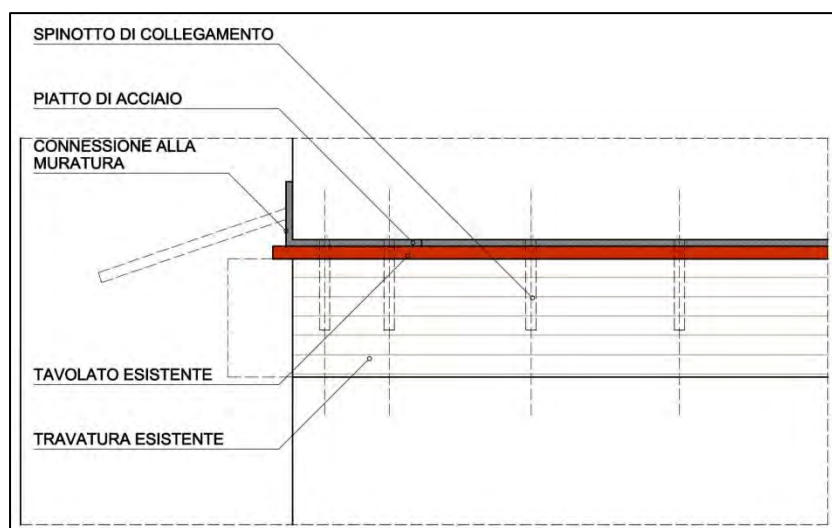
Sezione longitudinale solaio consolidato con profili metallici
